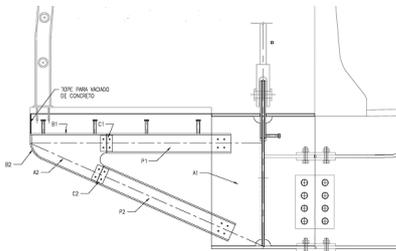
Detalle de la unión de la viga transversal y el voladizo
